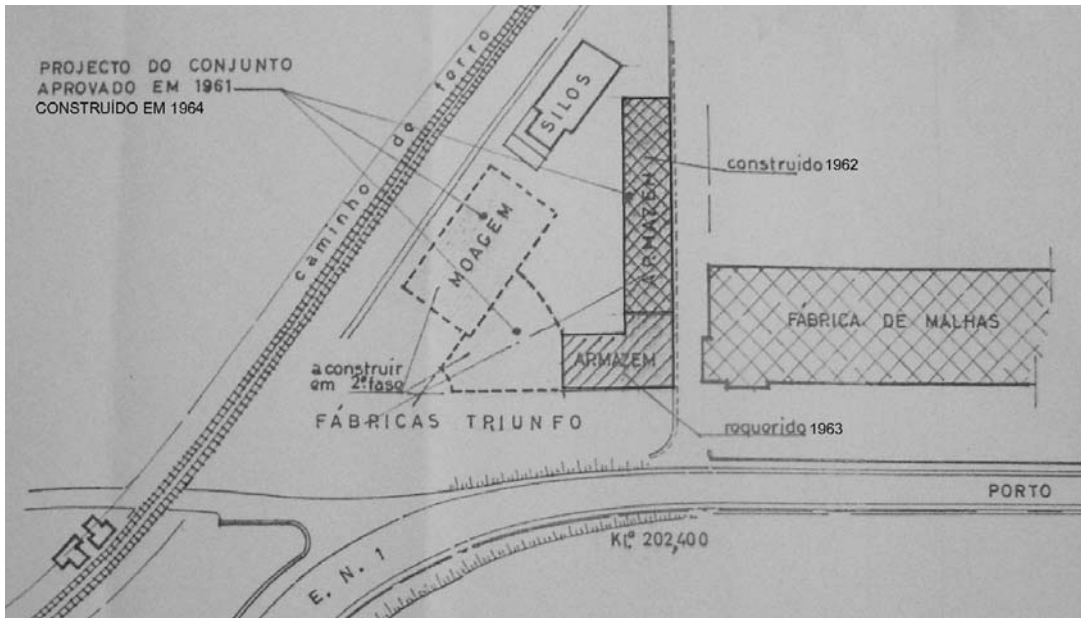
| Planta de implantação do projeto definitivo e as fases de construção
